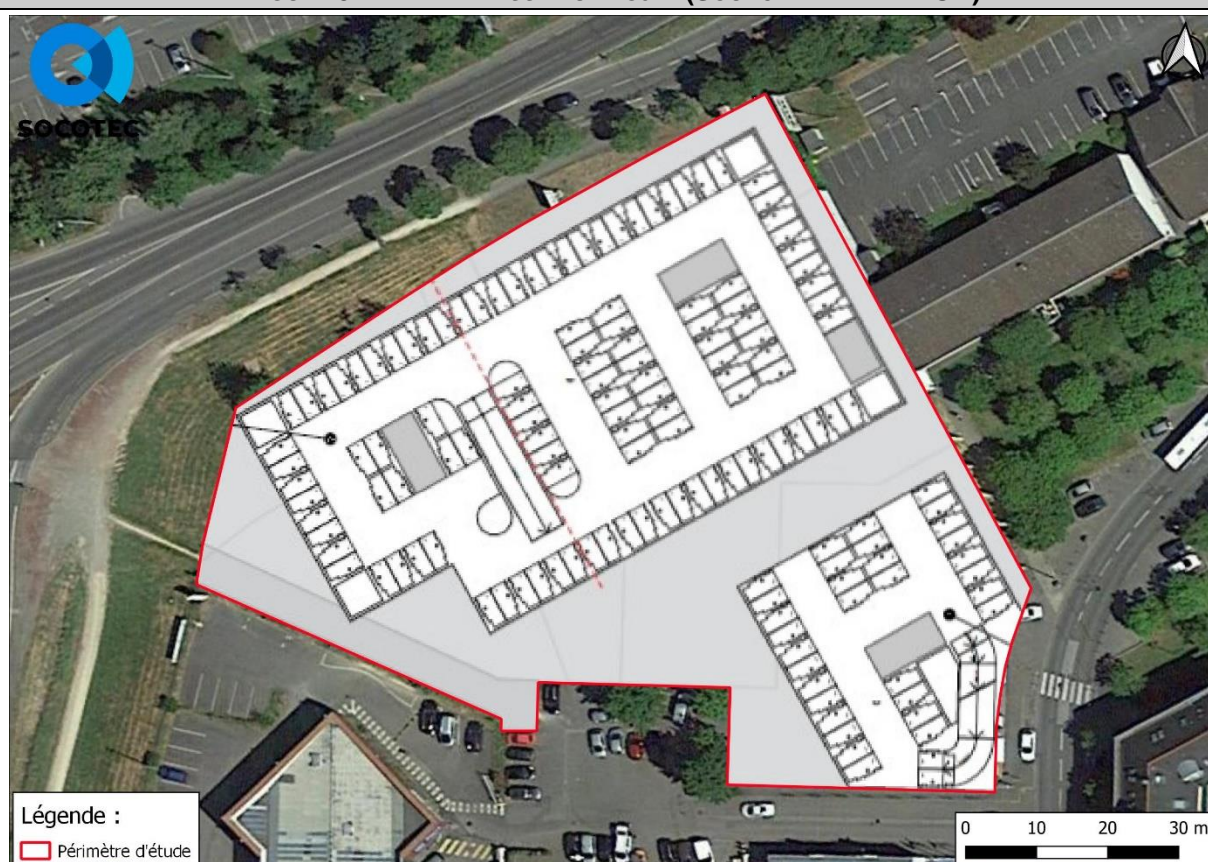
PLAN DES SOUS-SOLS (SOURCE : BATIARMOR)
